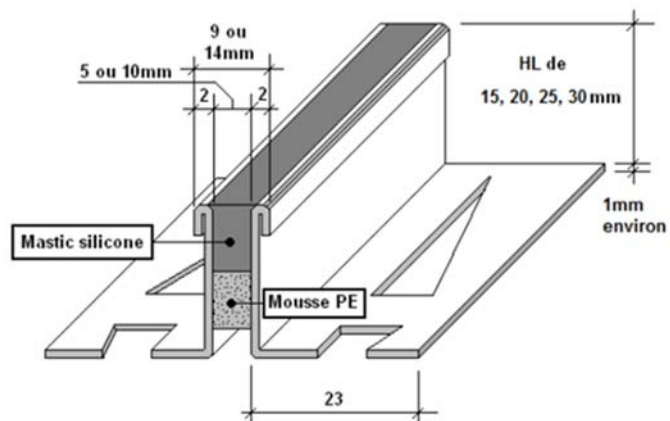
Joint de dilatation - Cas particuliers où une protection au passage d'eau apportée par l'entretien est demandée : système d'étanchéité de joint de dilatation sous Avis Technique (joint avec profilé métallique ponçable type DILAPARK ou MIGUTAN)
